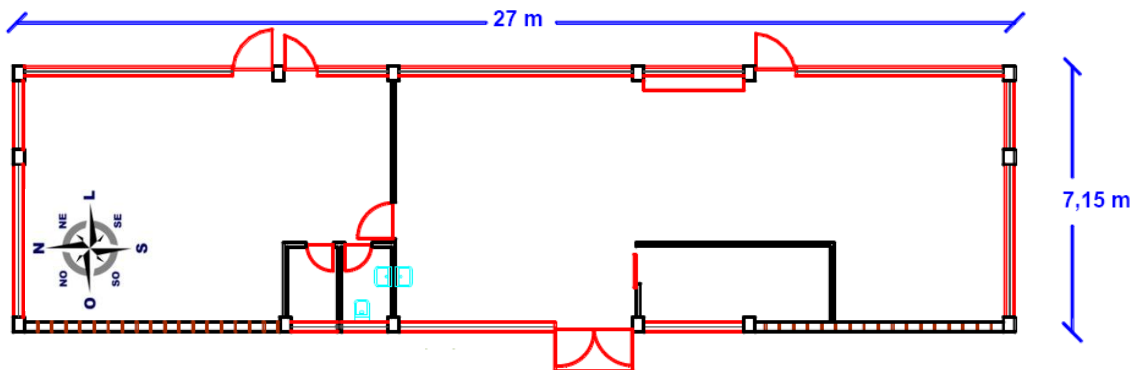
Planta do bloco em estudo. Adaptado de (Santos, 2010)
